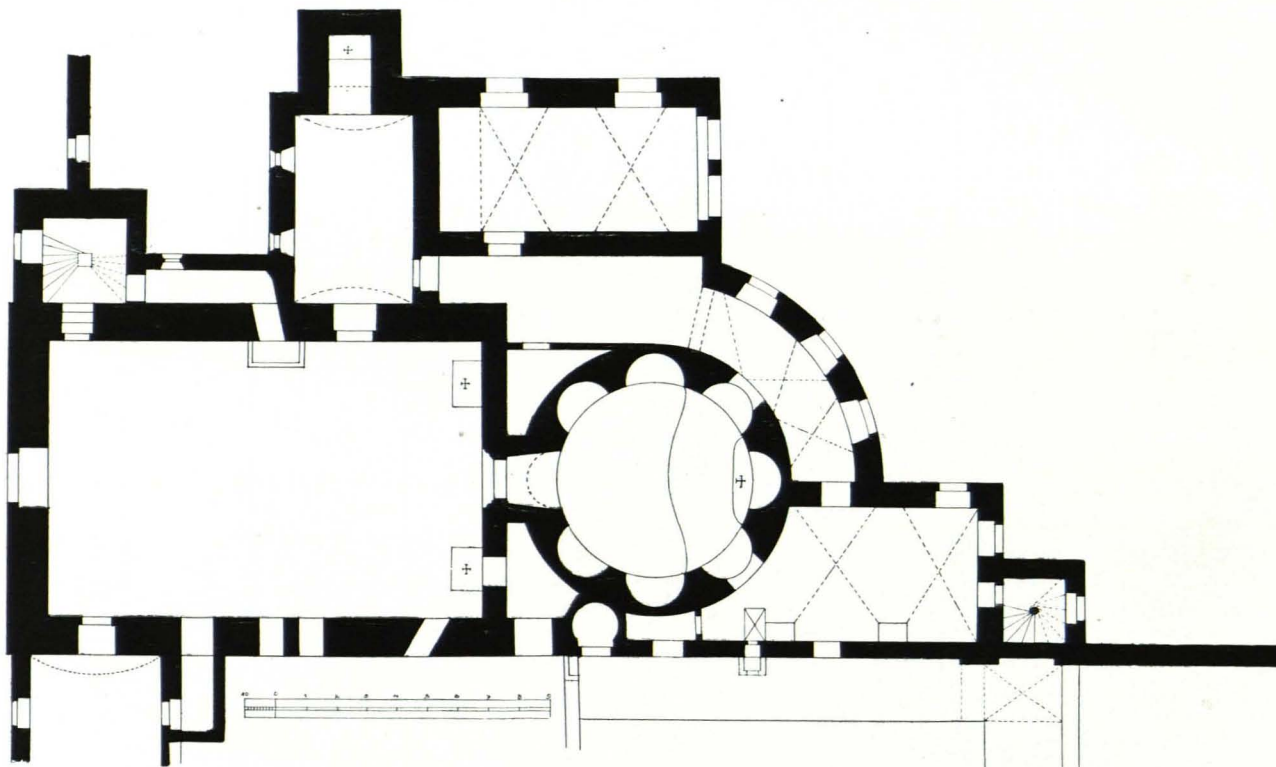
Loretto-Kirche, Grundriß 1 : 250 (S. 186; von N. nach S. orientiert)
